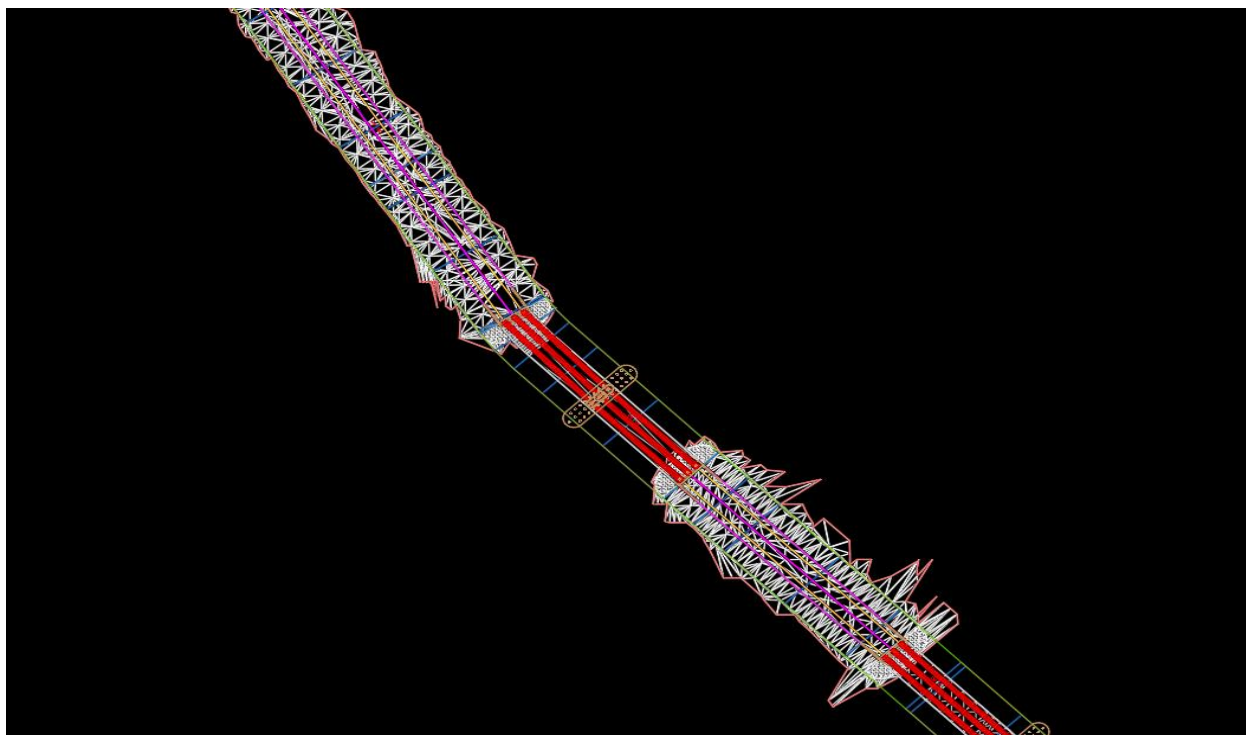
Vistas en planta de las vigas de los viaductos no convertida en sólido tridimensional y con multitud de caras, en AutoCAD Civil 3D.
